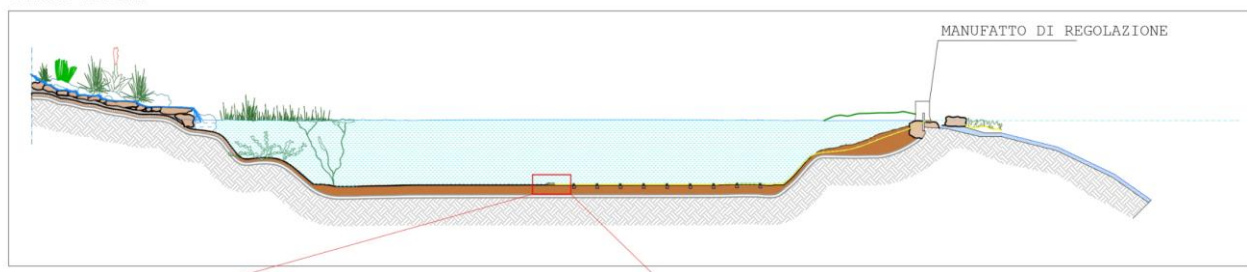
Sezione tipologica: posa di tubazioni sul fondo del lago, con scarico attraverso la briglia esistente opportunamente modificata, con funzionamento a sifone
